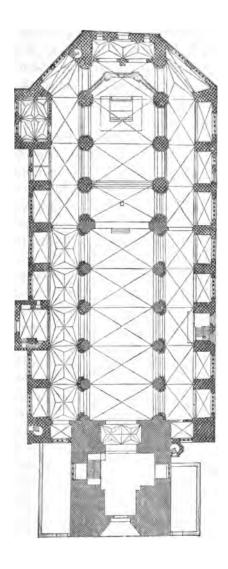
Greifswald. S. Nicolaikirche. Grundriss. 1:667.
